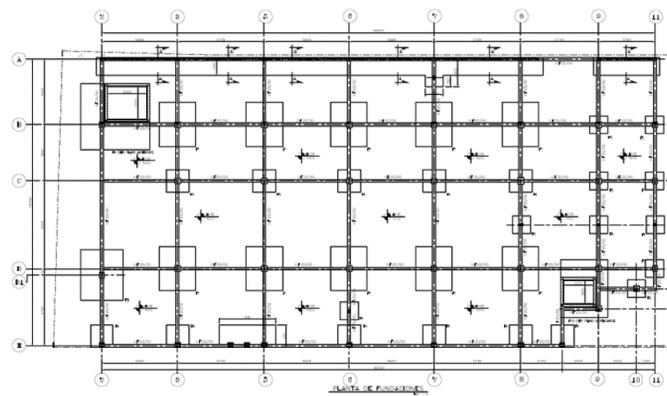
Planta de fundaciones edificio centro de tratamiento de diálisis renal Concepción
